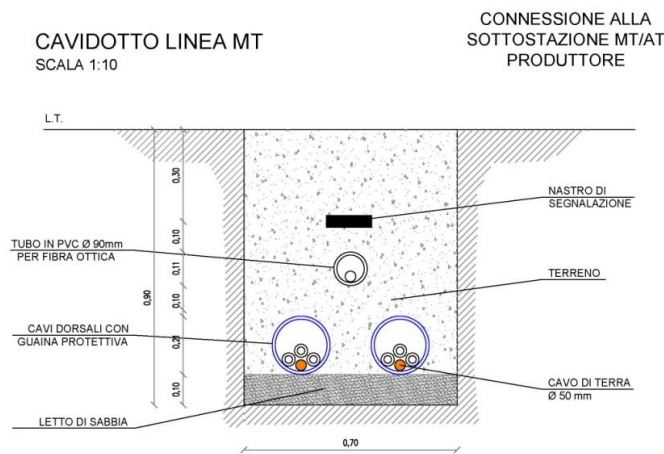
Sezione tipica di posa CEI 11-17 (cavidotto linea MT).
